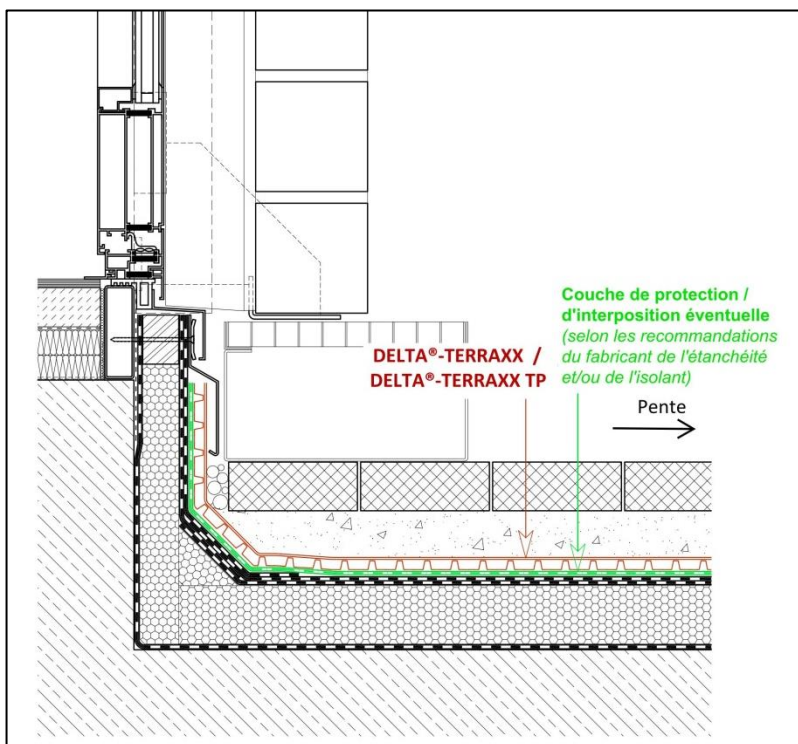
détail de seuil de porte avec membrane d'étanchéité bitumineuse + DELTA®-TERRAXX / DELTA®-TERRAXX TP (protection lourde avec dalles ou pavés)
